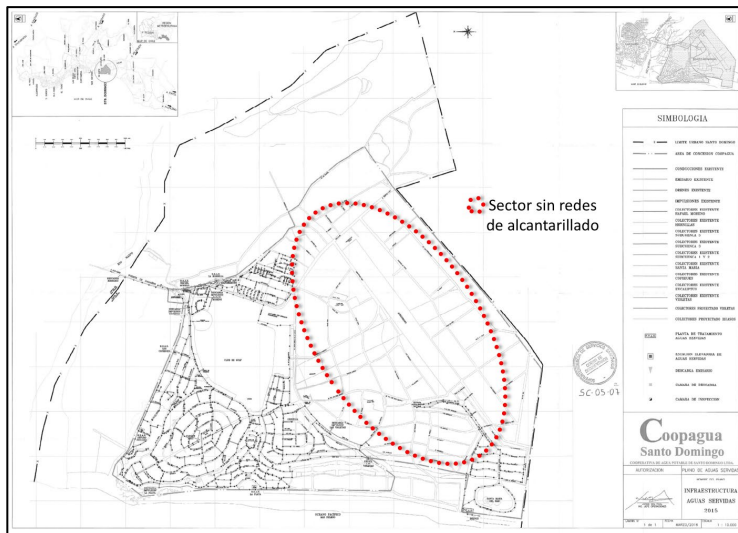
Red de Alcantarillado –Rocas de Santo Domingo
